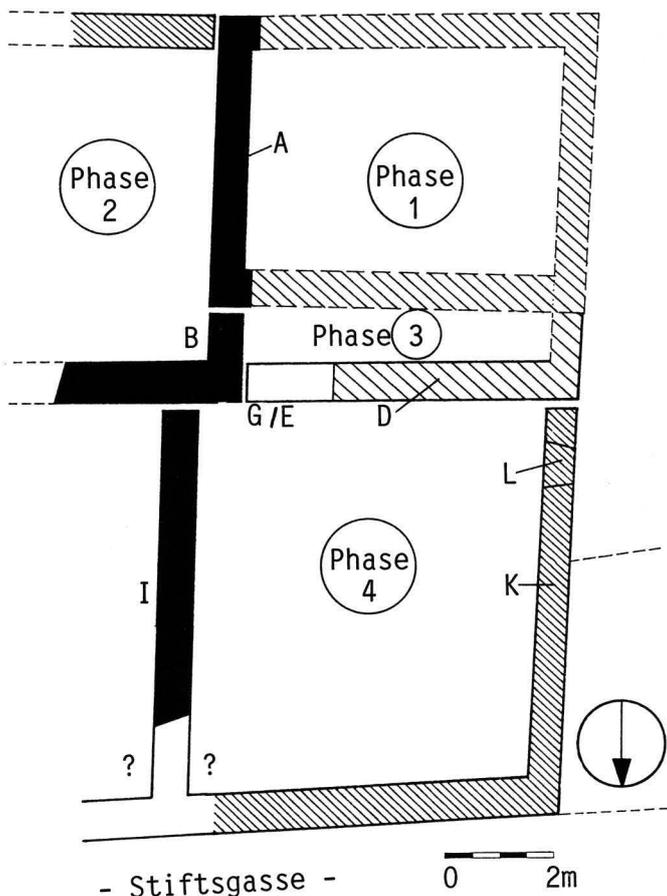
Stiftsgasse 5. Grundriss des Erdgeschosses. Schwarz: Mauerverlauf gesichert, schraffiert: Mauerverlauf wahrscheinlich. – Zeichnung: St. Tramèr.
